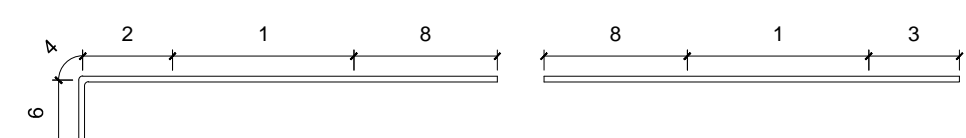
DETAIL TULANGAN BALOK INDUK EKSTERIOR
